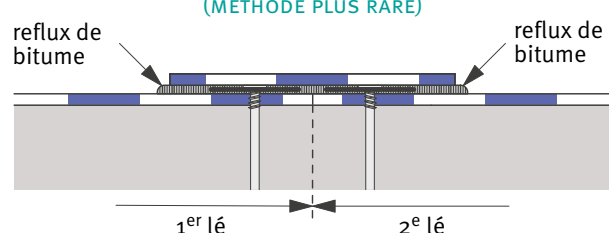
Fixation mécanique d'une étanchéité bitumineuse monocouche.
